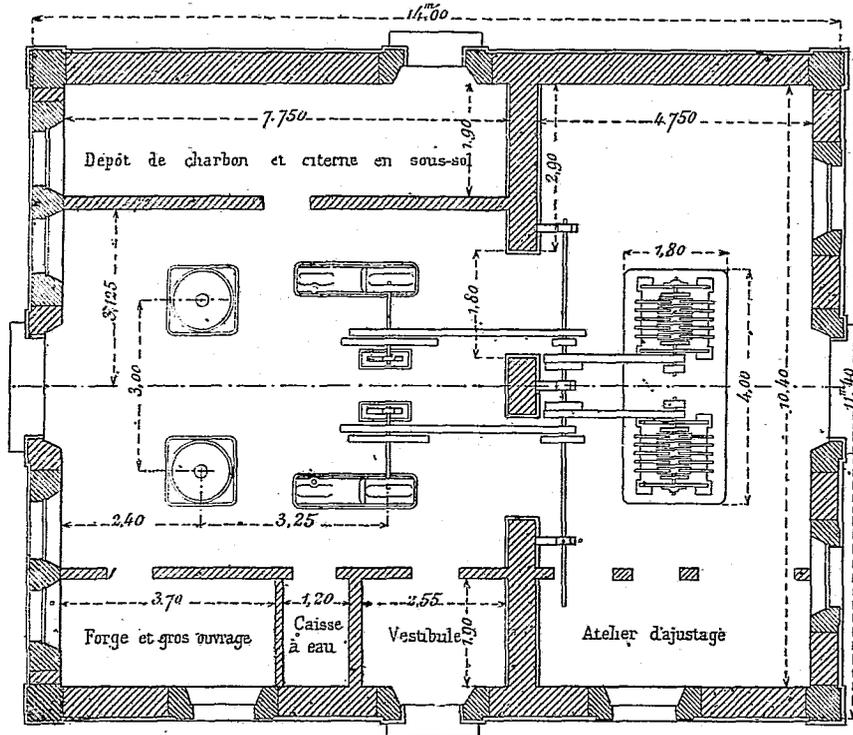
Phare de Planier. Plan d'installation des machines électriques.
